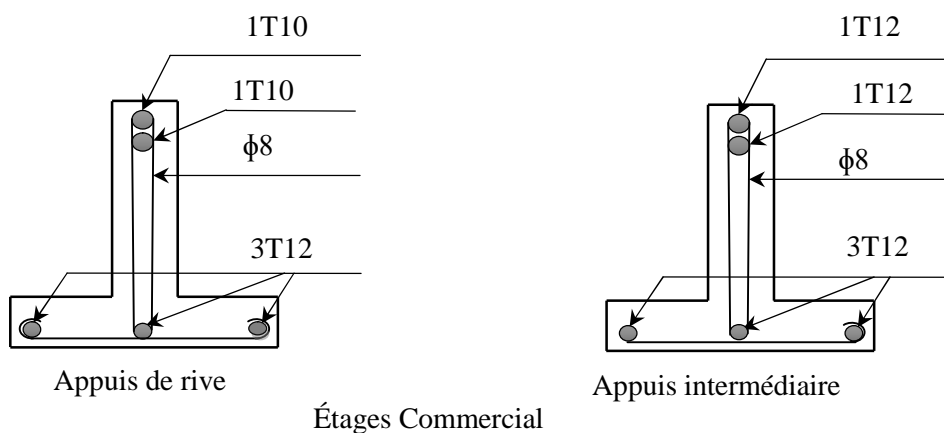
Dessin de ferrailage des poutrelles des étages commercial.
